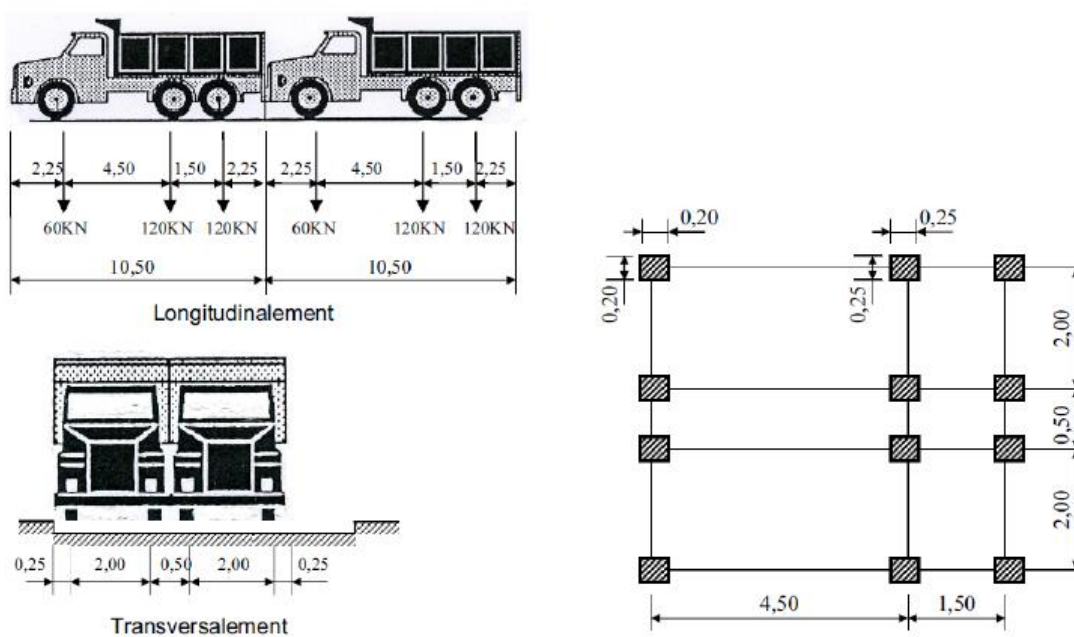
Système B_c longitudinalement, transversalement et en plan.
